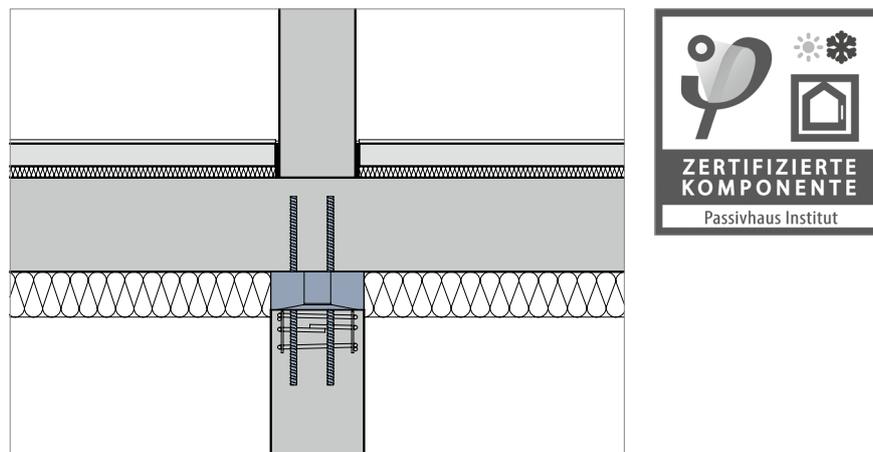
Schöck Sconnex® type P pour poteau intérieurs et isolation sous la dalle
